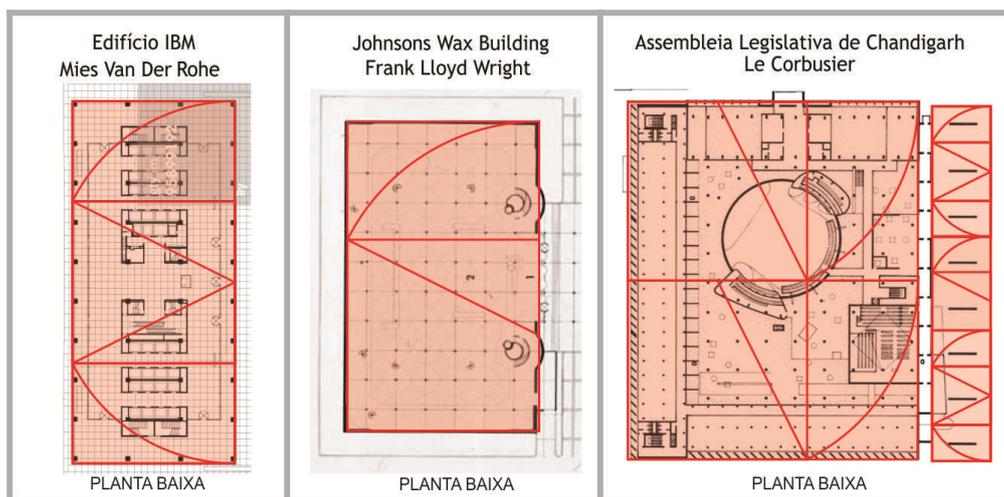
Análise das plantas dos edifícios administrativos. Fontes: planta à esquerda (Blessing, 1971); planta ao centro: <http://www.planetclaire.org.>; planta à direita (Clarck & Pause 1996)
